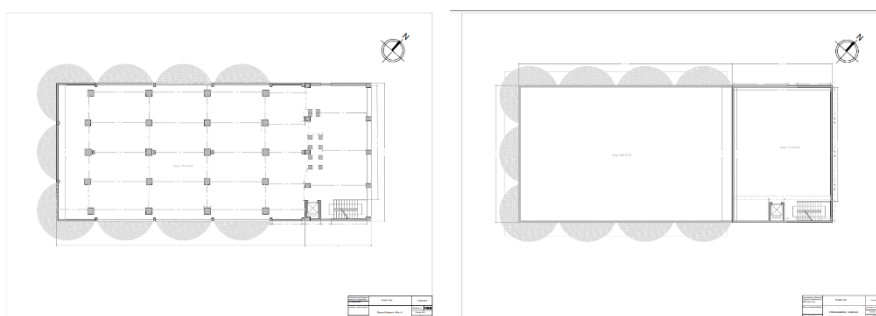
Plantas existentes: Piso 9 e Cobertura
